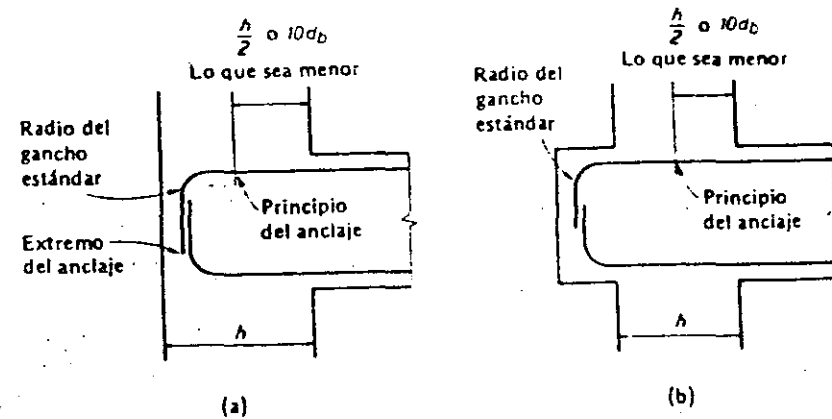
Anclaje de las varillas de la viga en una columna exterior, cuando es factible que se forme la articulación plástica en la viga en el paño de la columna. a) Anclaje en las columnas. b) anclaje en el talón de la viga.
